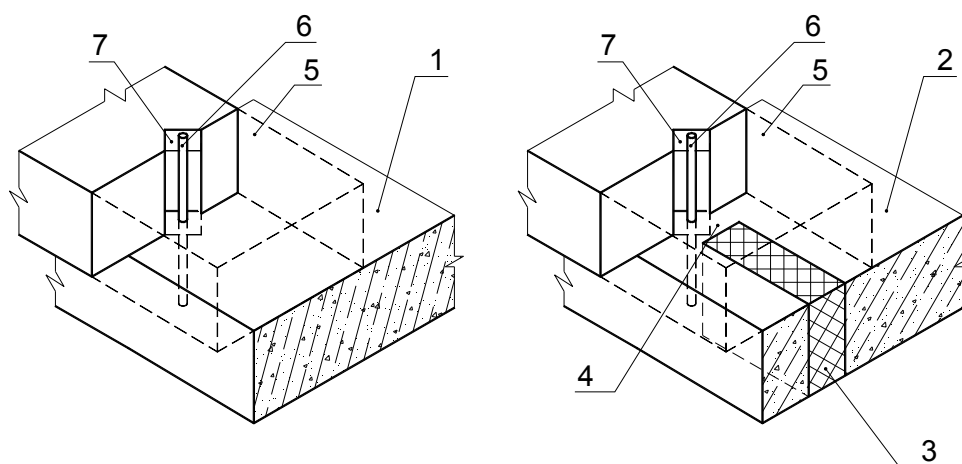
Устройство анкерных выпусков перекрытия для фиксации наружных стен
